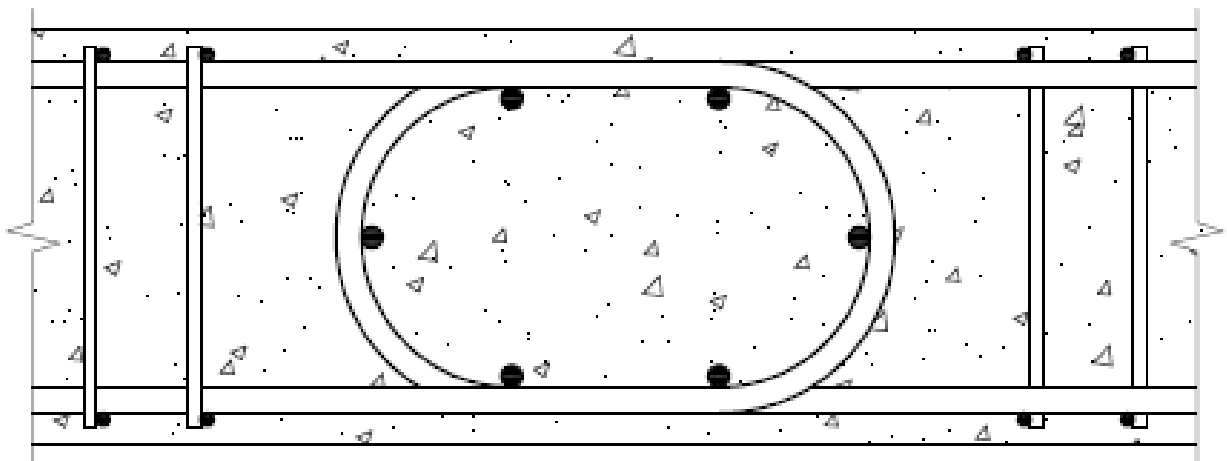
Петлевой стык арматуры с продольным армированием ядра.
